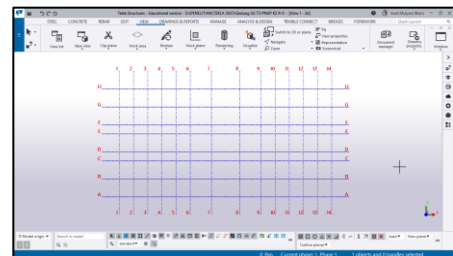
Layout Lantai 1 Gedung Sekolah Teknik Sipil Kampus 2 PNUP
